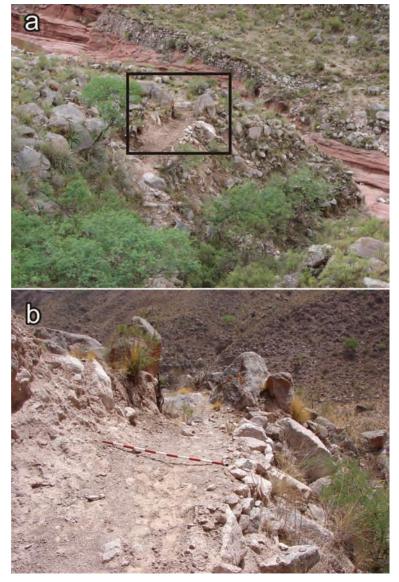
a) Punto de acceso a la quebrada y camino en cornisa con talud ladera abajo y excavación ladera arriba; b) Detalle del punto de acceso.
